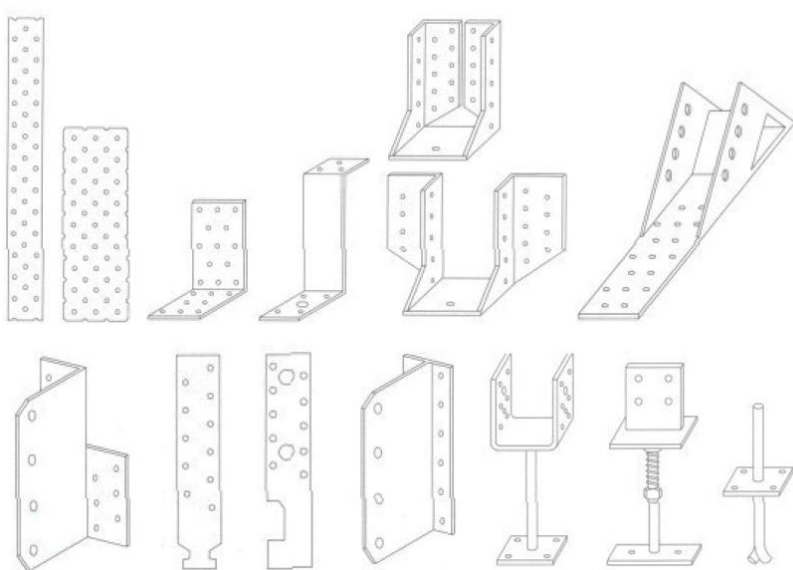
Detalhe das ligações. Fonte: “Timber Construction”; in detail Praxis; Friedemann Zeitler; Alemanha; 2004; Pag. 74
